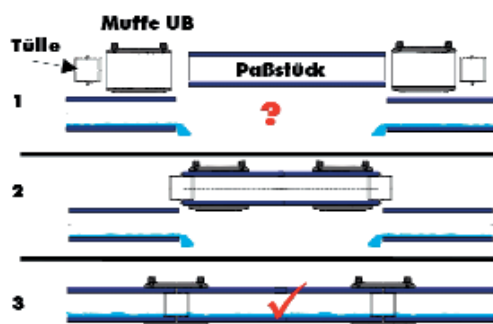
Монтаж ремонтной ставки для устранения остаточной воды из зоны сварки
